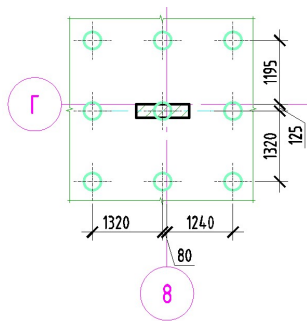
Схема расположения свай под фрагмент плитного фундамента
